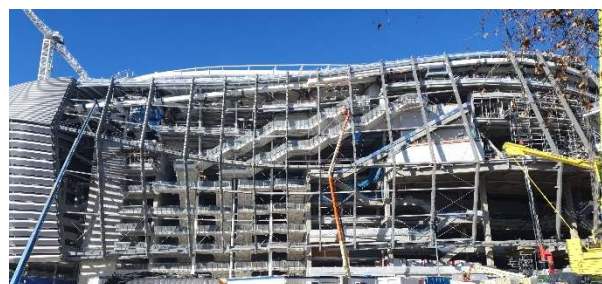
Vista frontal del nuevo edificio del este donde se puede ver la subestructura de bastidores que dan soporte a la fachada de laminales. Calle de Padre Damián
